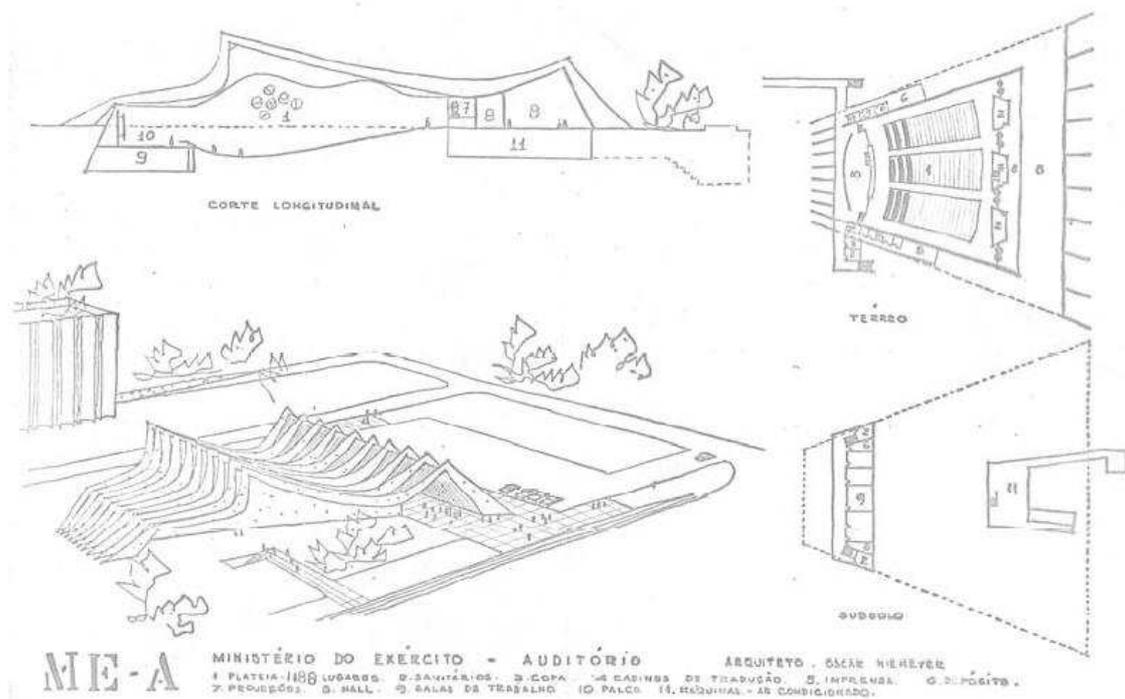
Planta do térreo e subsolo, perspectiva geral e corte.
